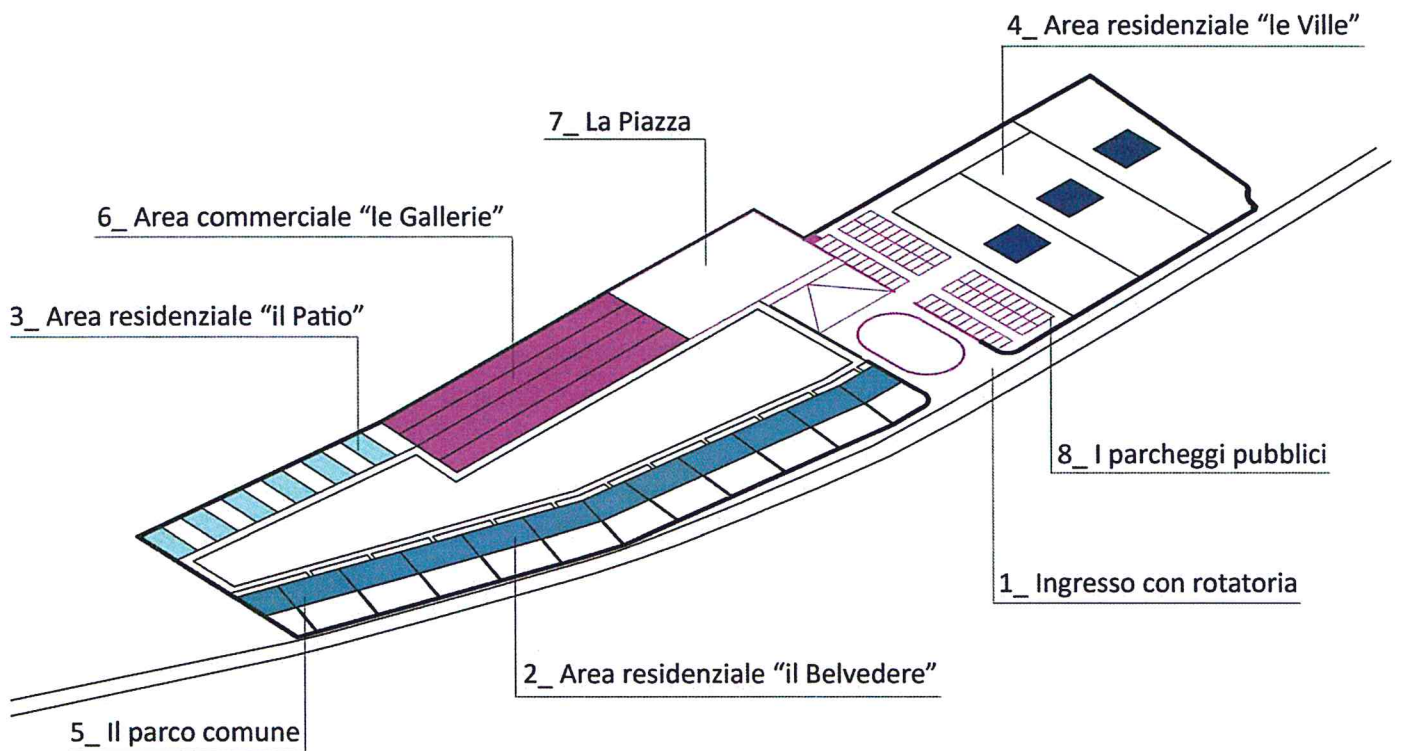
Assonometria schematica dell'ipotesi di progetto.
